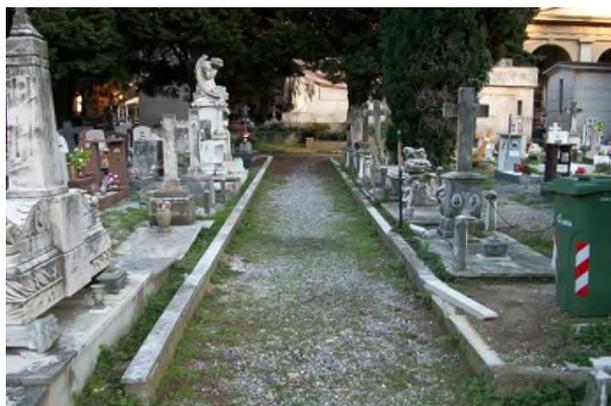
Intervento 7- Vialetti interni, tipica pavimentazione cimiteriale
